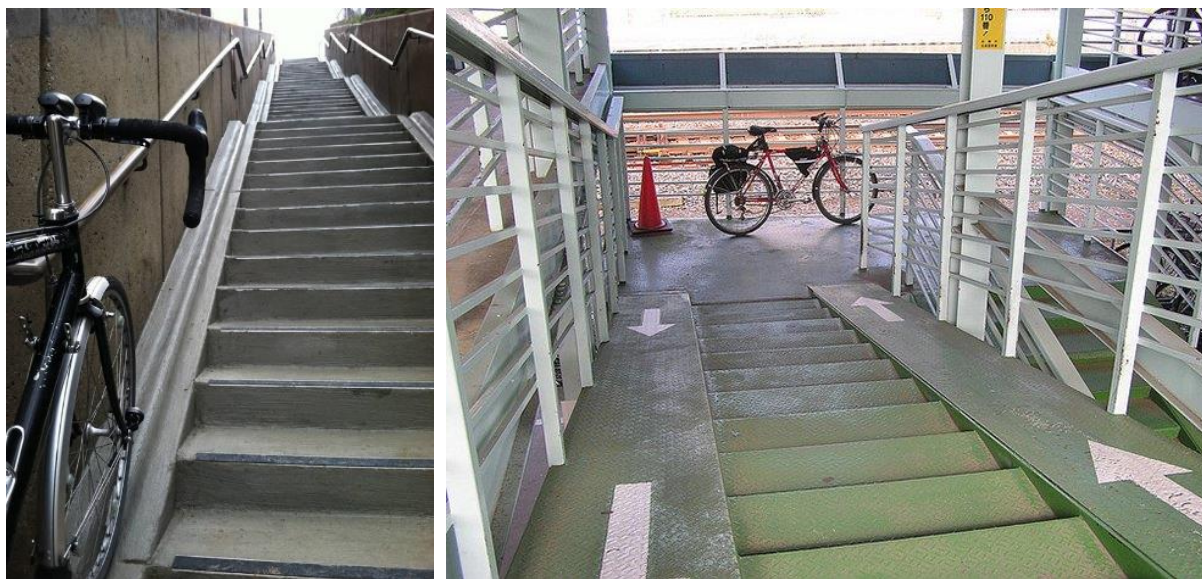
A - EXEMPLOS DE CANALETAS RAMPEADAS EM ESCADAS FIXAS <sup>54</sup>
